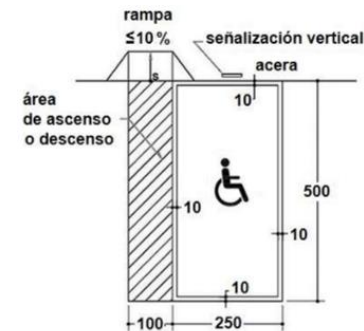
Planta de un Estacionamiento: Rectángulo delimitado por una franja con espesor de 10 cm con las dimensiones indicadas anteriormente, conteniendo el símbolo de accesibilidad y la indicación de una rampa próxima a uno de los laterales
